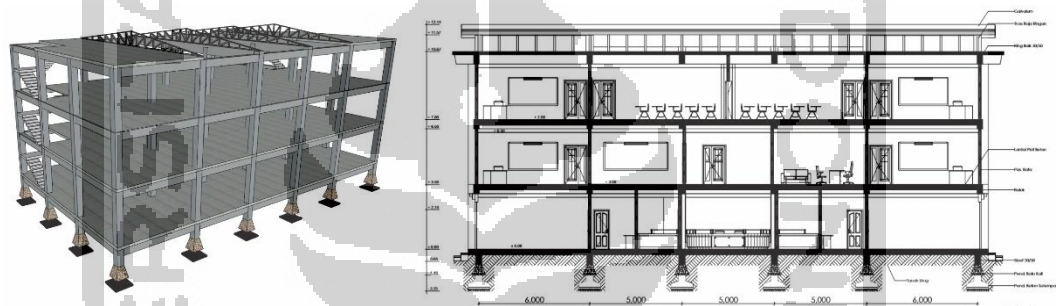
Sistem Struktur Proyek Rumah Tinggal
